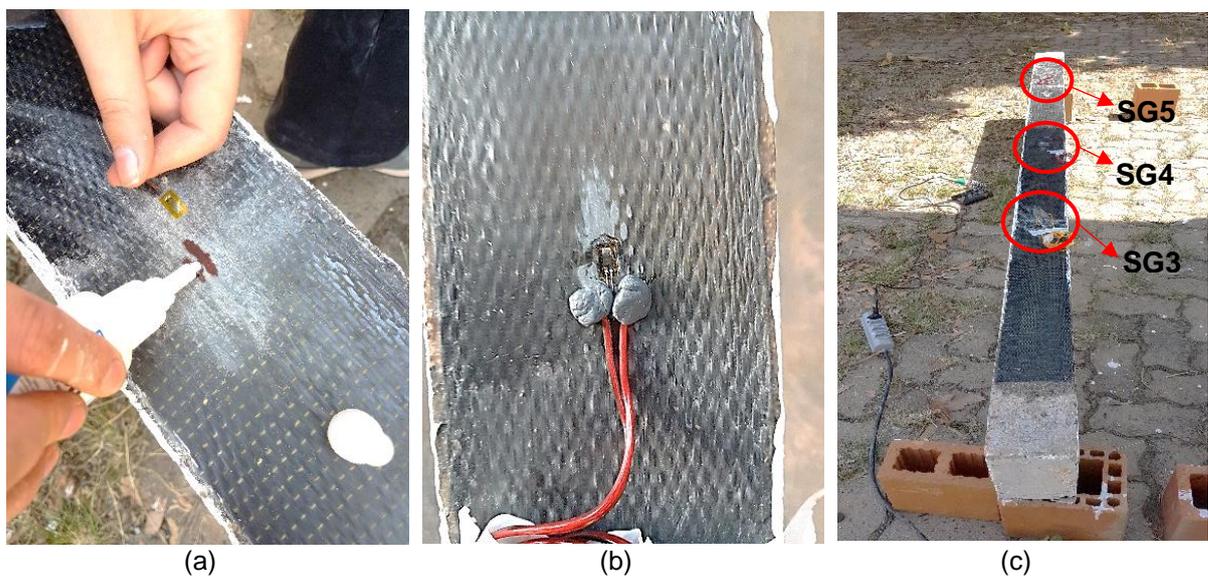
(a) Demarcação do centro da barra longitudinal, (b) Fixação do extensômetro
